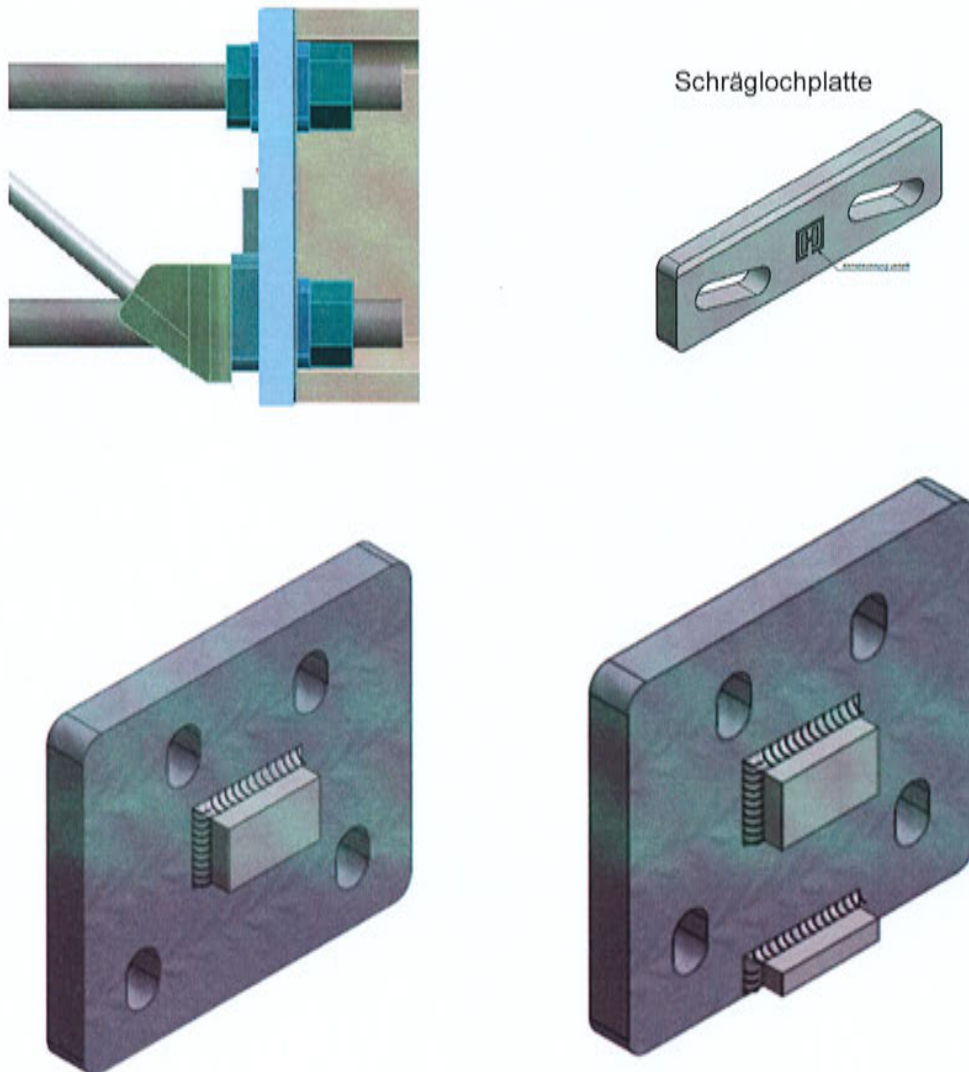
Exemplarisch – HIT – HP/SP – SDV Element mit montierter Stirnplatte mit Knaggen / Schräglochplatte / Positionsblech / Stabwerk aus Zug-, Druck- und Querkraftstäben
